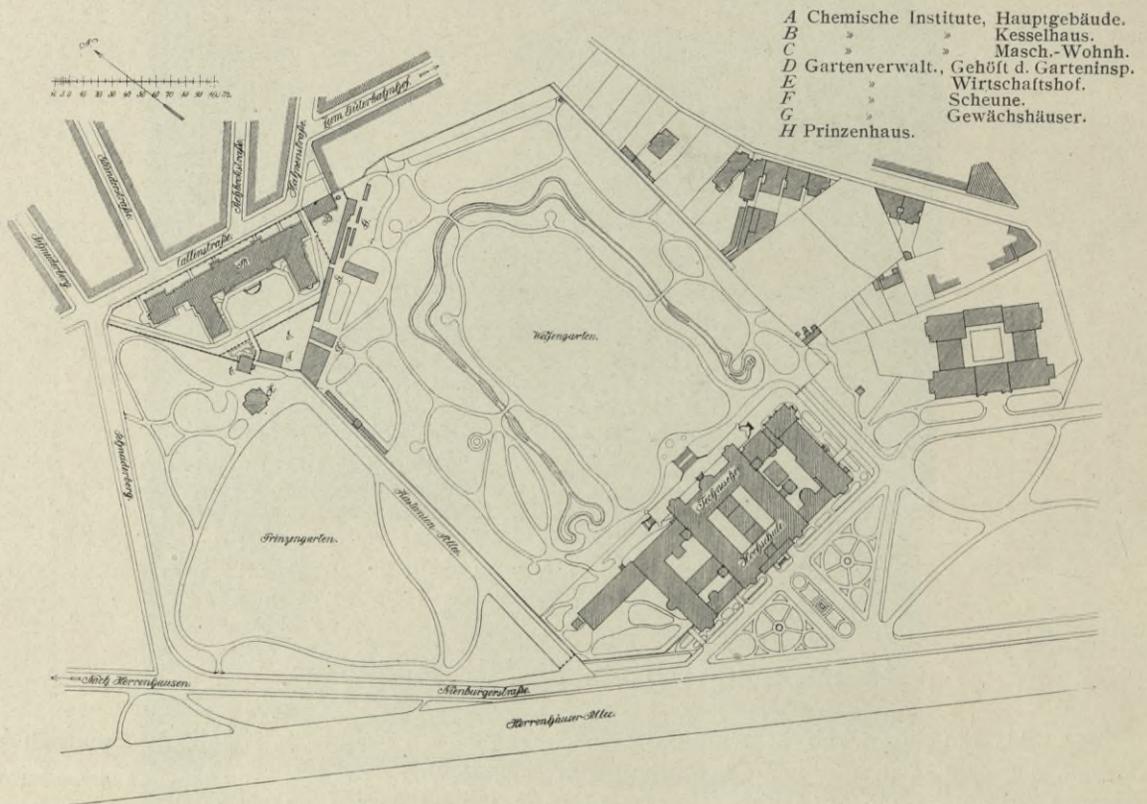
Gesamtanlageplan der Hochschulgebäude.
